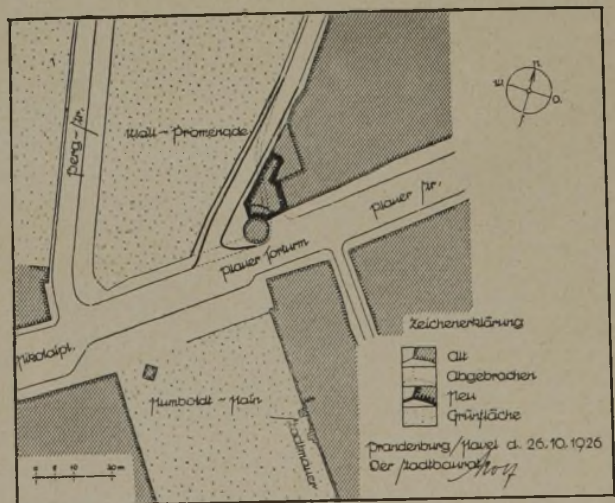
(rechts). Lageplan d. Anbaus am Plauer Torturm.
